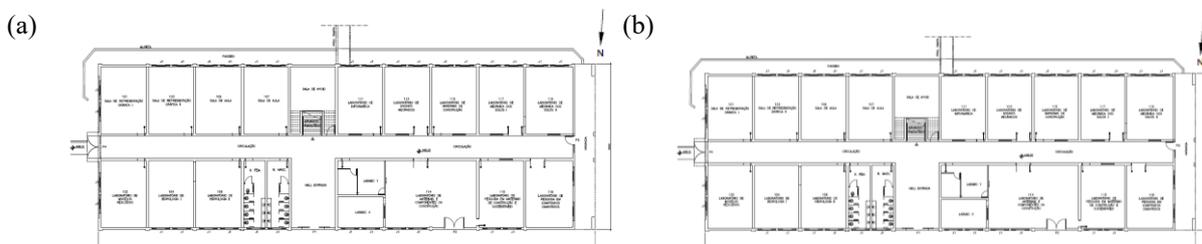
Plantas baixas do (a) 1º pavimento e (b) 2º pavimento do Prédio 12. Fonte: Adaptado de Divisão de Projetos do CEFET-MG.
